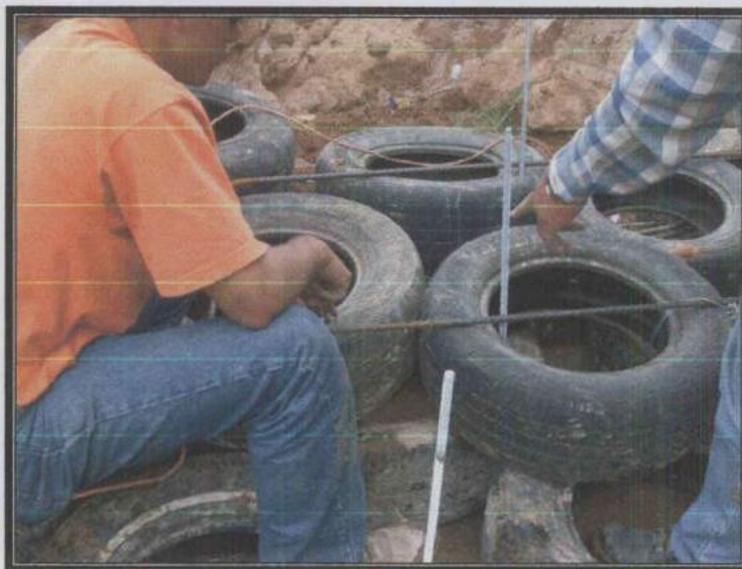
Refuerzo de la estructura en el plano horizontal) con varilla
